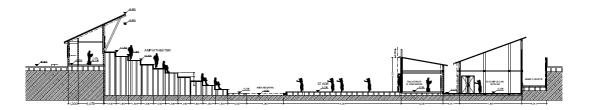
18. Potongan Bangunan C-C (R. Badminton & Voli)
